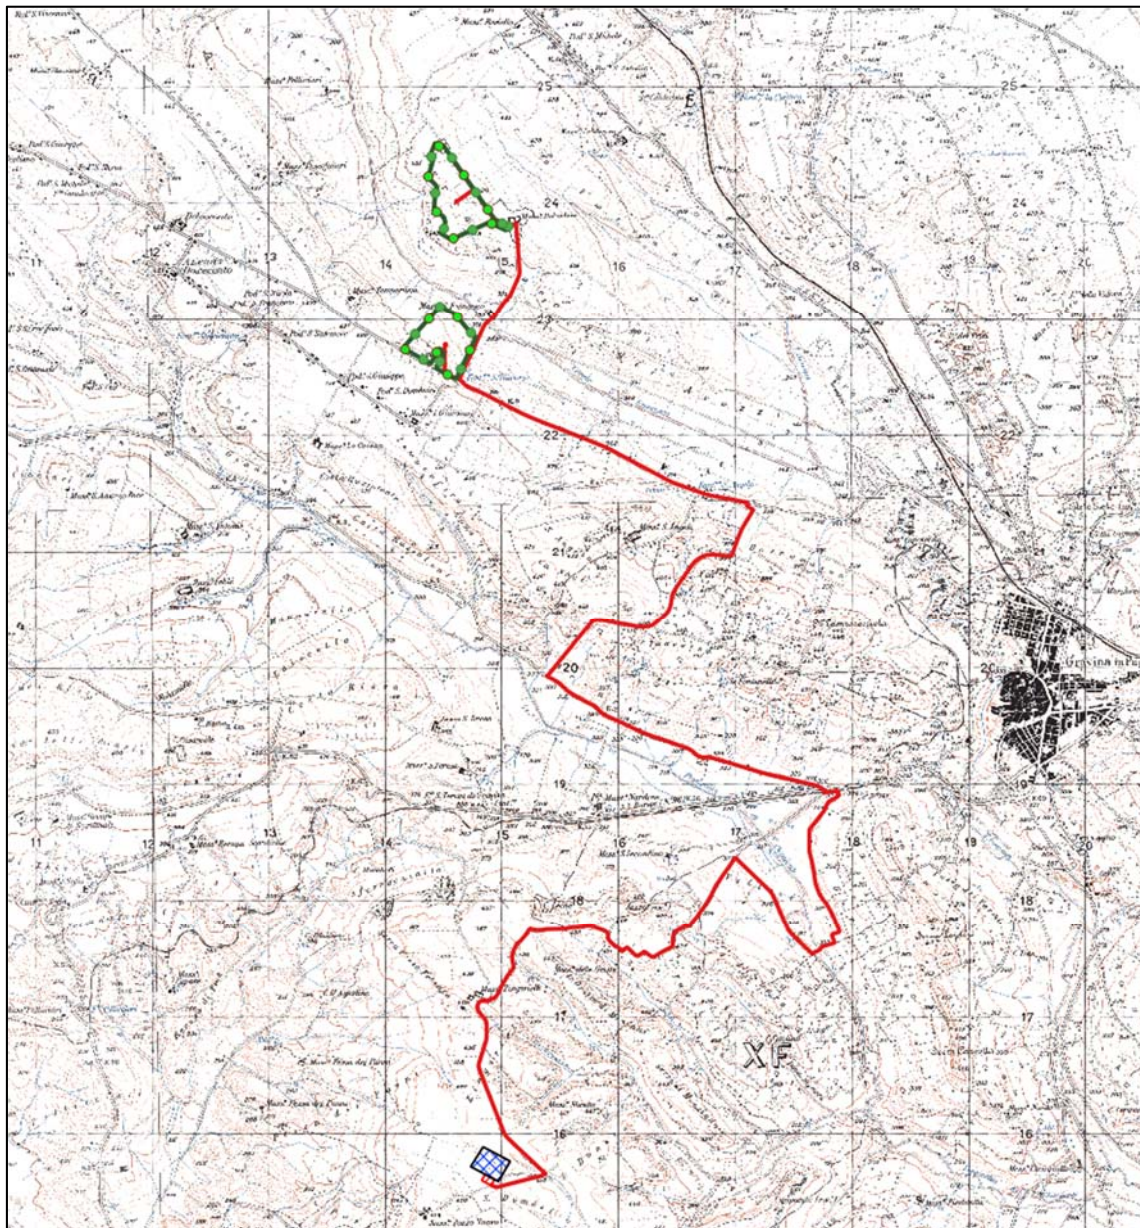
Planimetria generale dell'impianto fotovoltaico su base IGM
